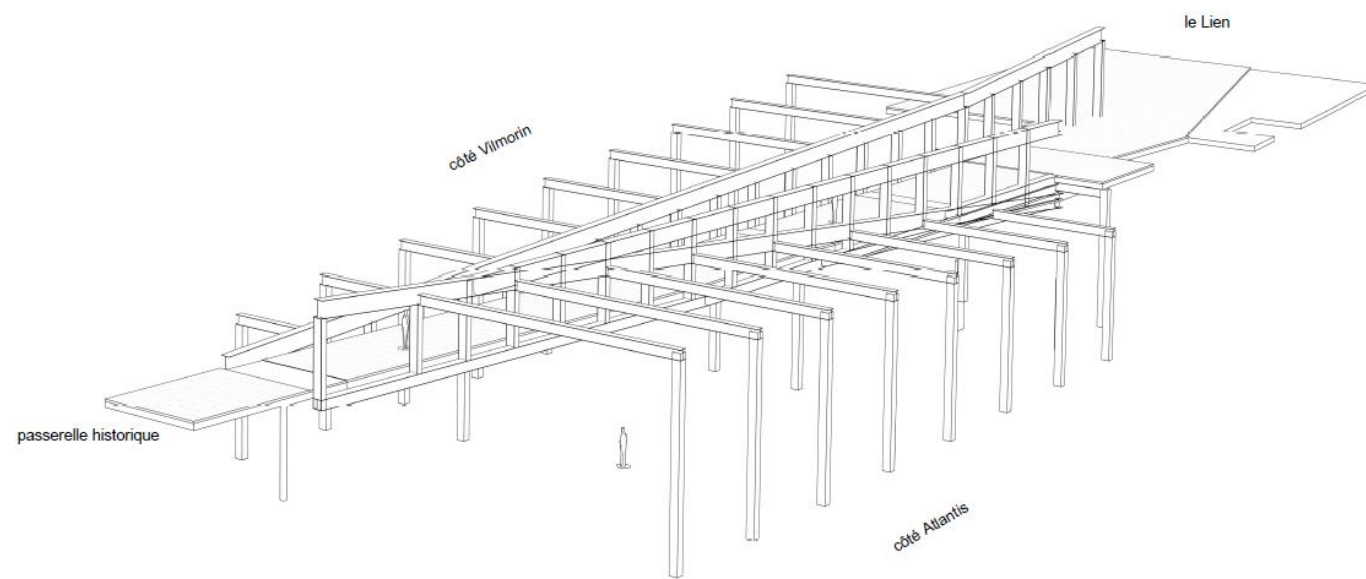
Le principe structurel construit la volumétrie de l'émergence
